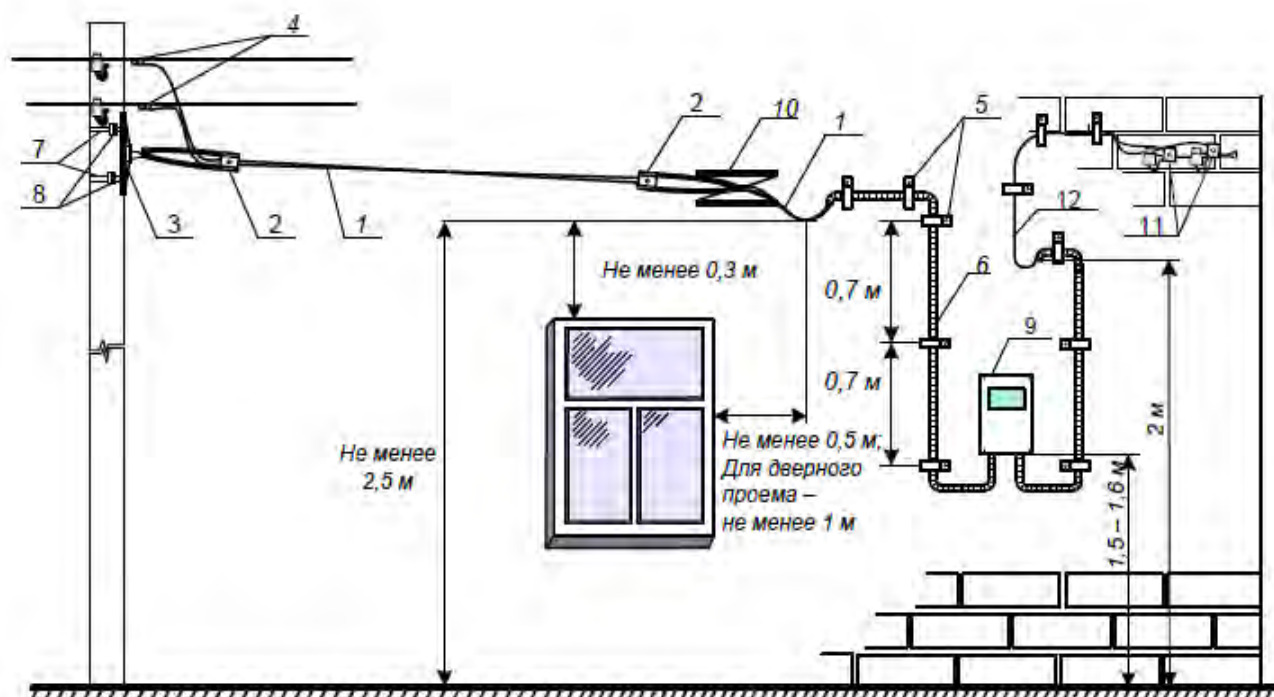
Монтаж узла учета электроэнергии на фасаде здания
